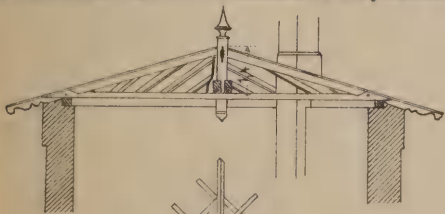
Keltendach über rechteckigem Grundriss.
